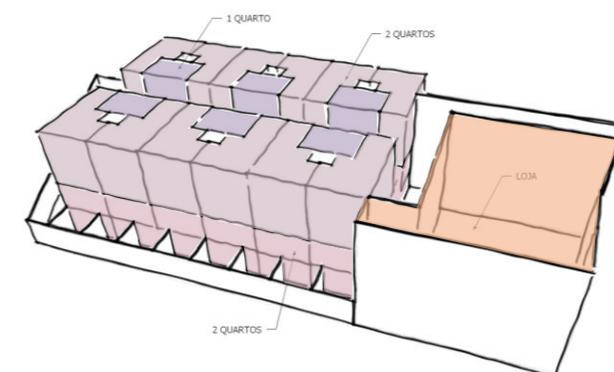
Esquema de planta para opção seguindo diretrizes. Fonte: Projetado pela autora.
